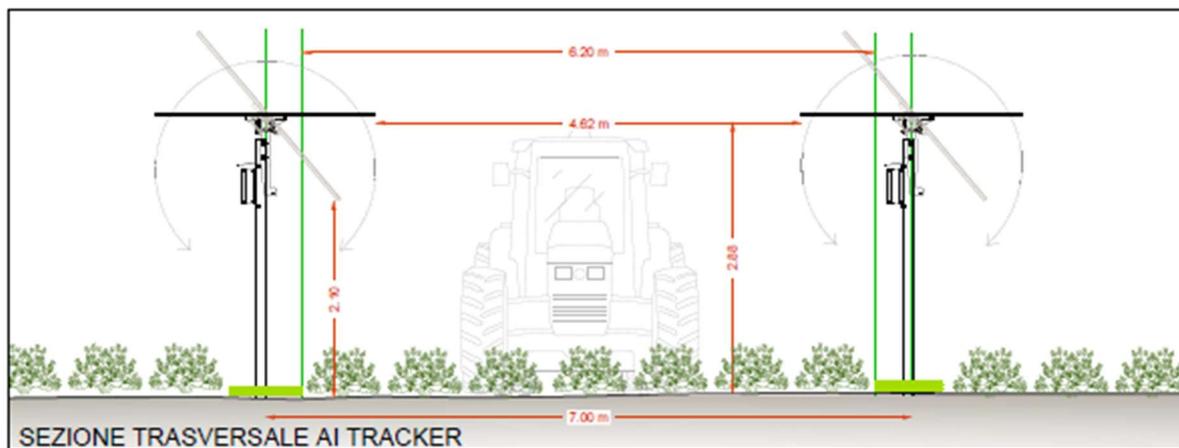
Sezione trasversale ai tracker con passaggio di trattore agricola
